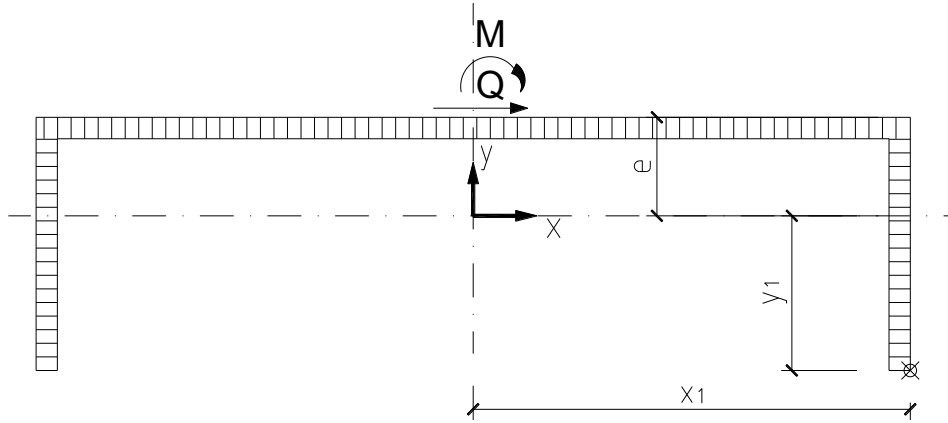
芯板与边界梁柱的连接角焊缝
